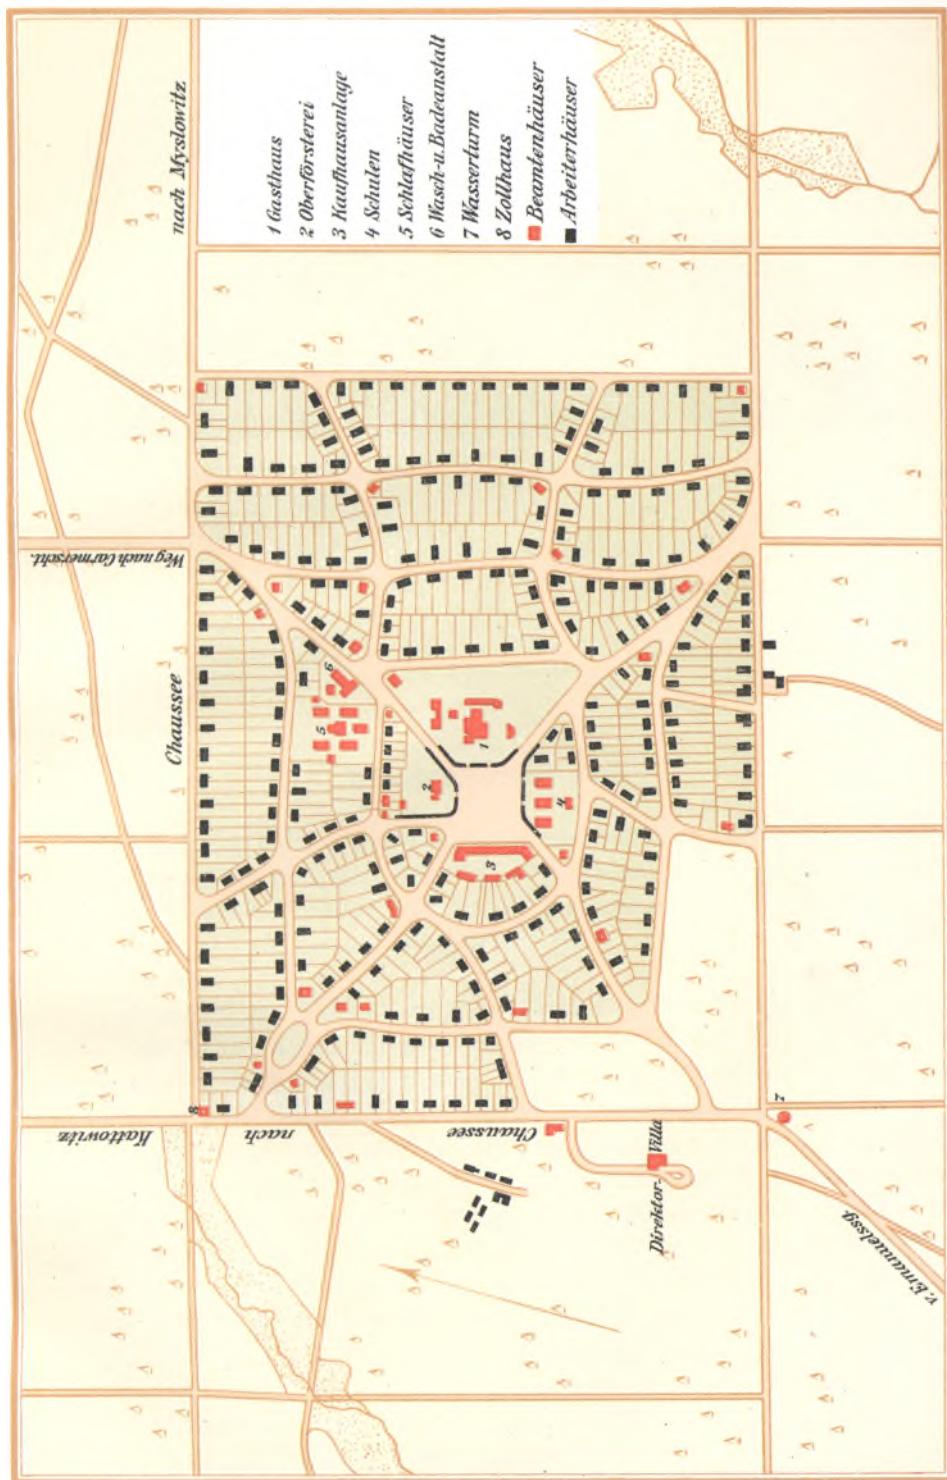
Kolonie Gieschewald. Lageplan 1 : 10 000.
